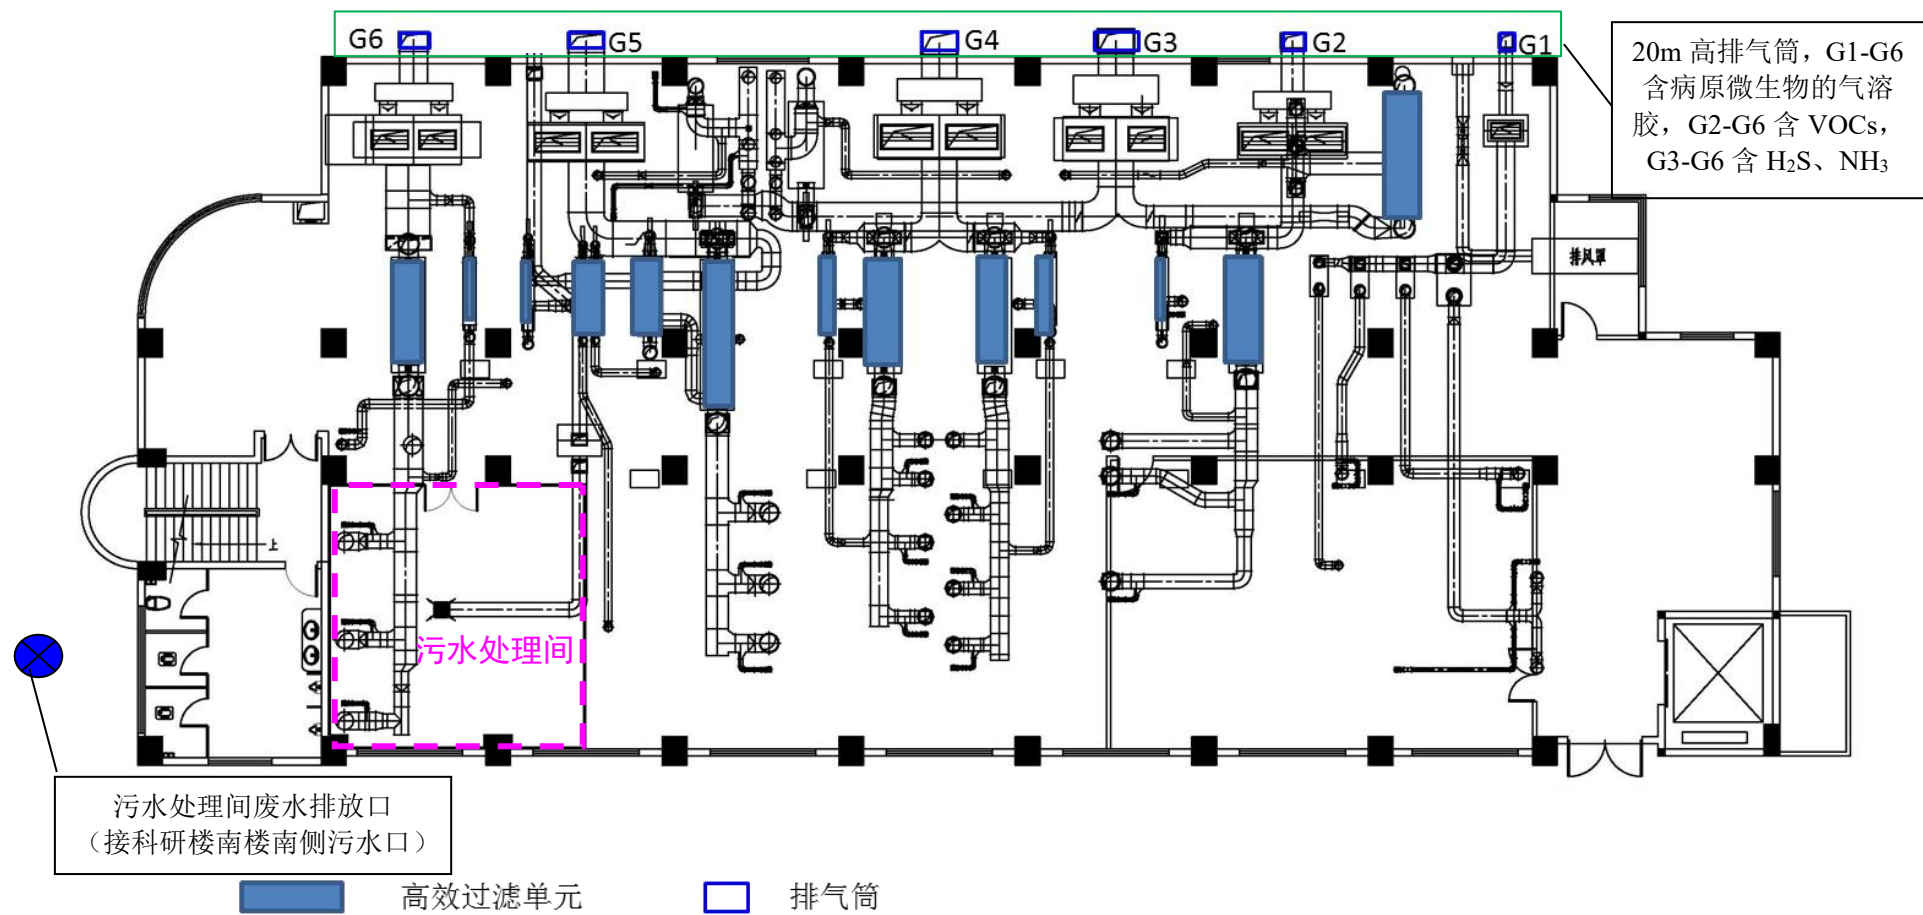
废气及废水治理设施（科研楼北楼 2 层）平面布置图
